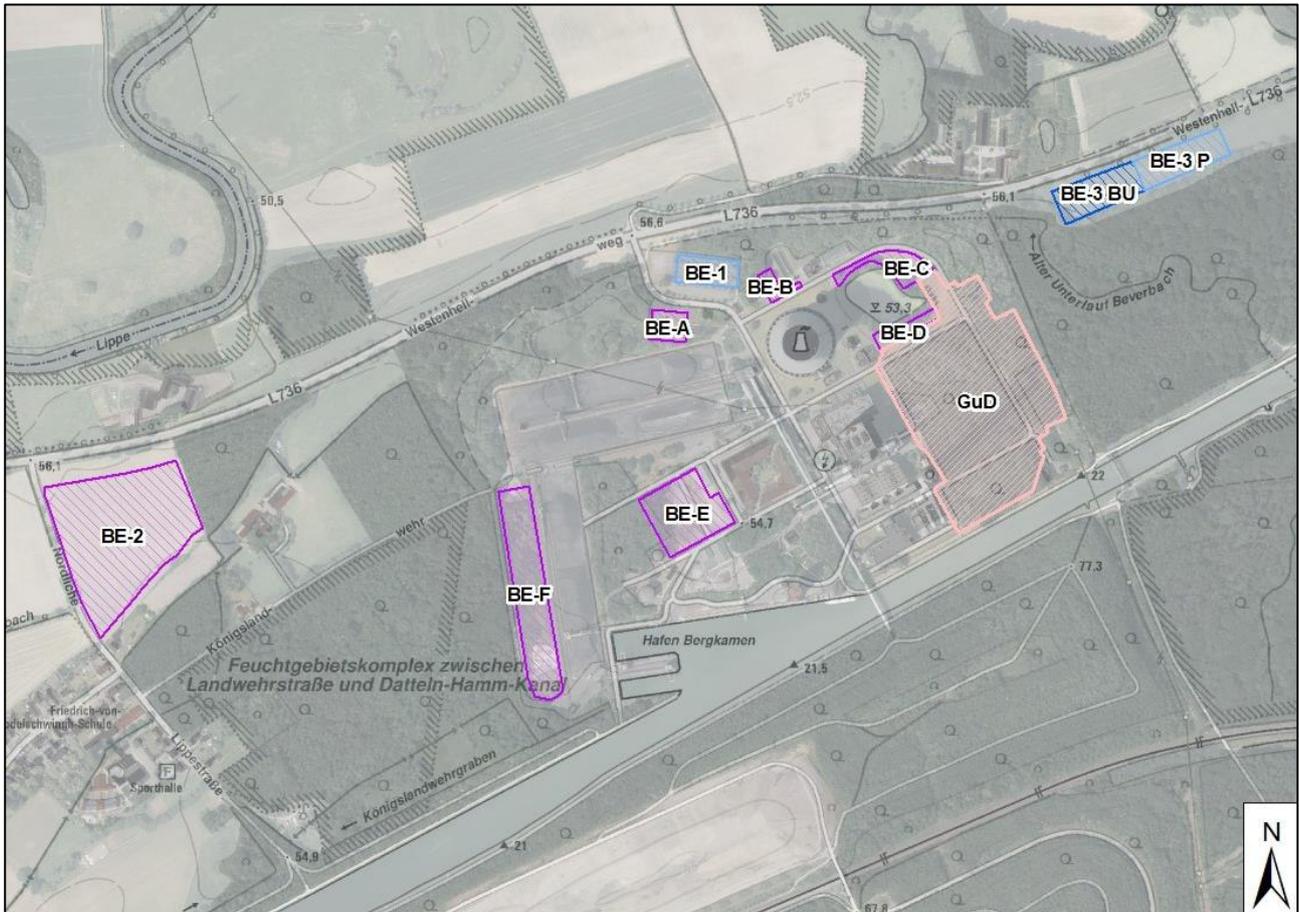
Eingriffsbereiche für die GuD-Anlage und Baustelleneinrichtungsflächen
